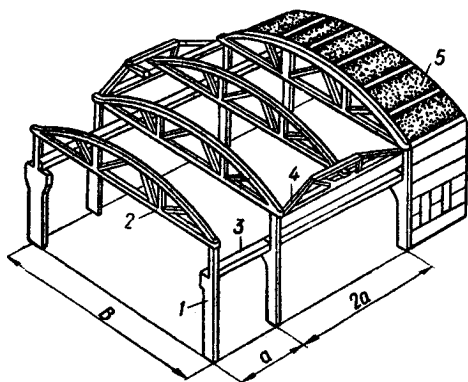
Каркас одноповерхової будівлі (залізобетонний):
